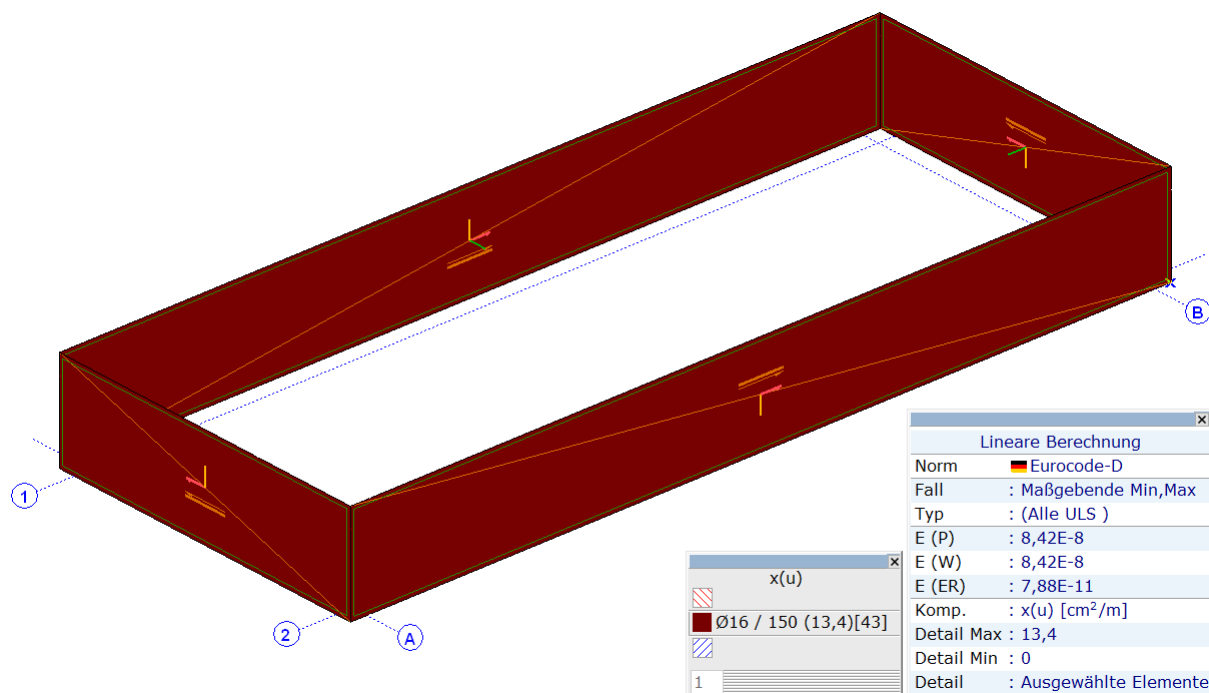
Entworfenere Bewehrung außen in lokaler x-Richtung (horizontal)
